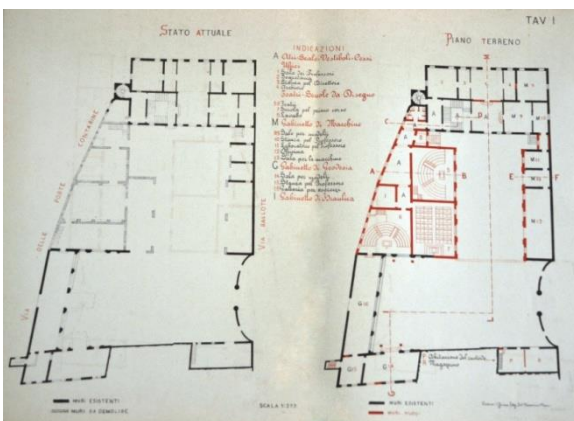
Pianta del piano terra prima e dopo il progetto
